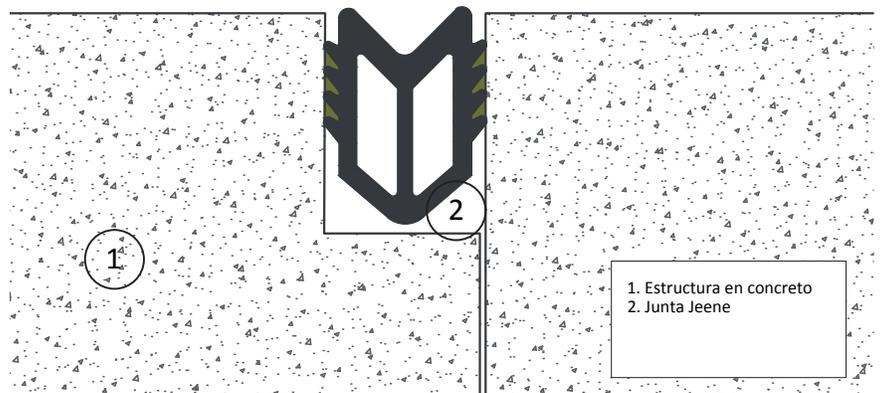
Detalle constructivo en junta. Con sello preformado y labios en concreto.
